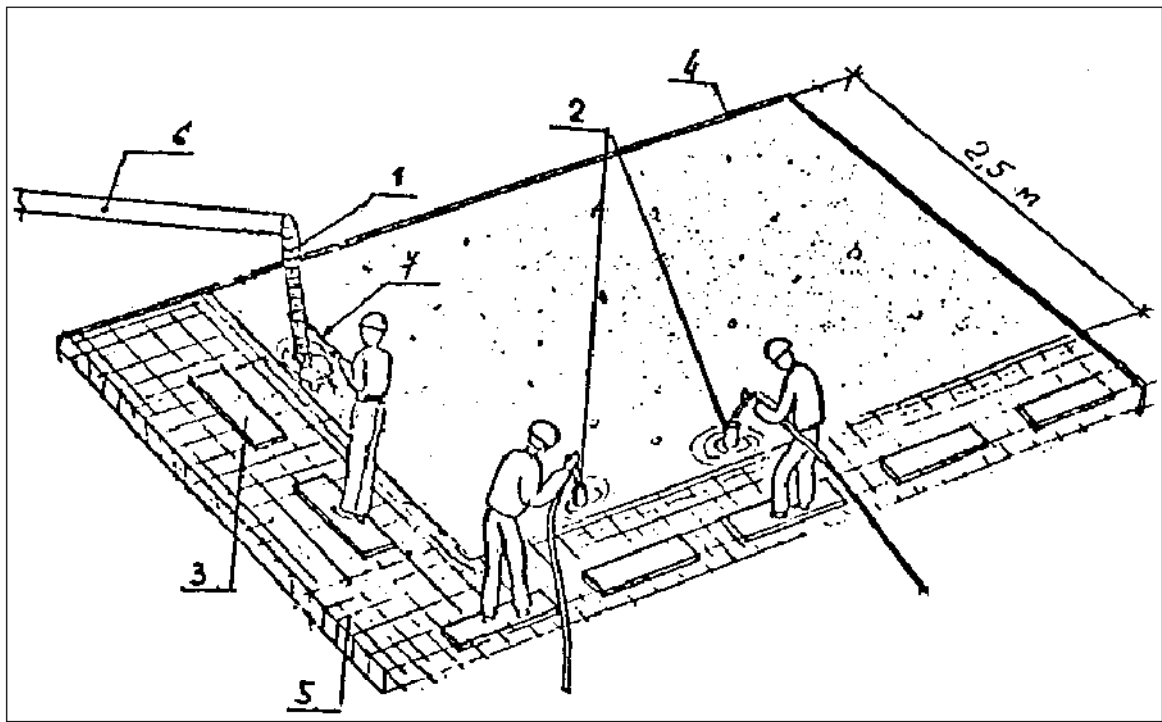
Схема організації робочого місця при бетонуванні
